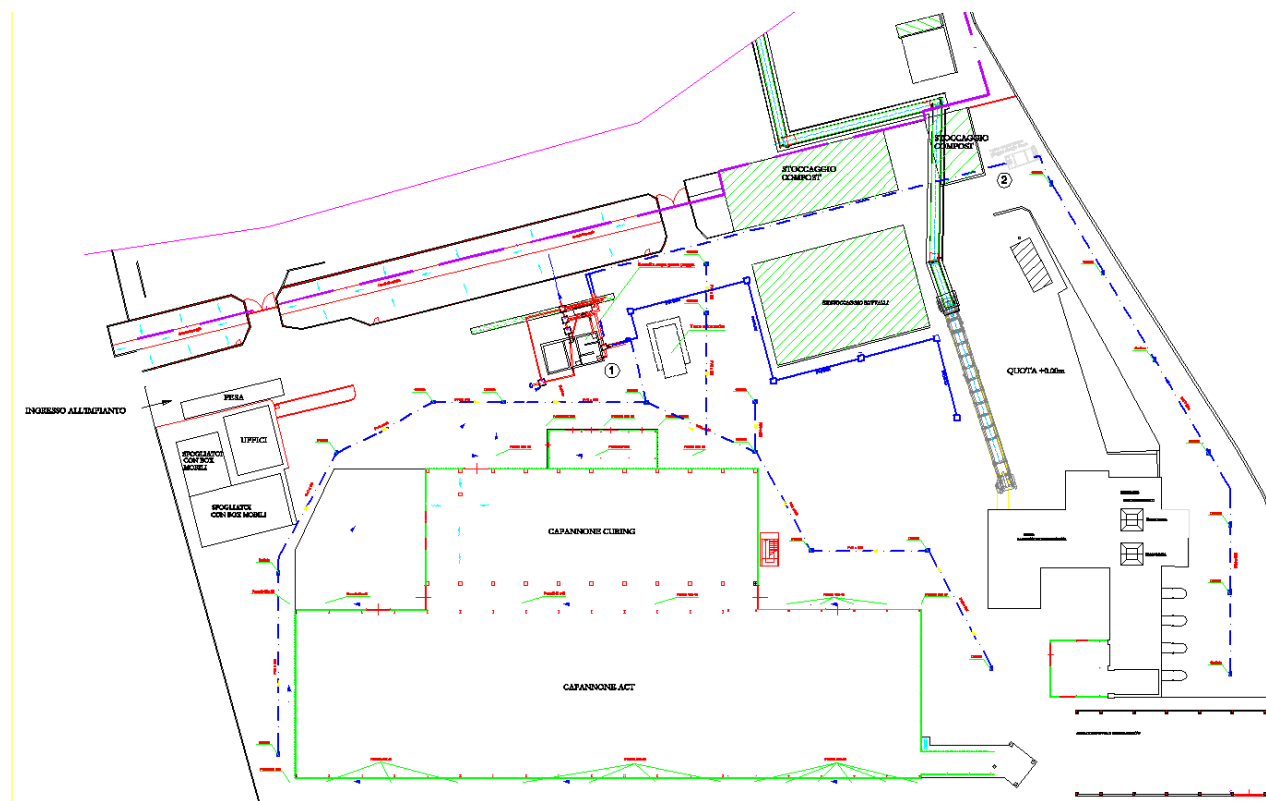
Planimetria reti acque meteoriche di piazzale esistenti
